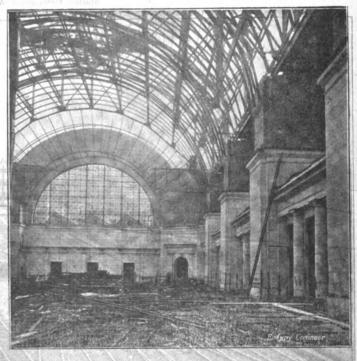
Stazione ferroviaria di Washington. - Sala d'aspetto in costruzione
